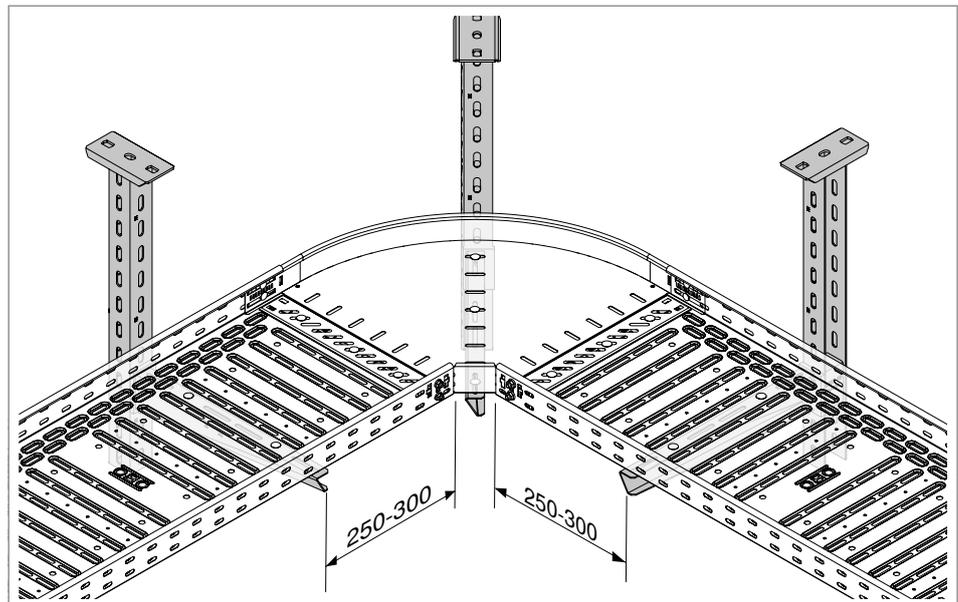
Ejemplo apoyo pieza prefabricada curva de 90°, 400 mm de ancho
